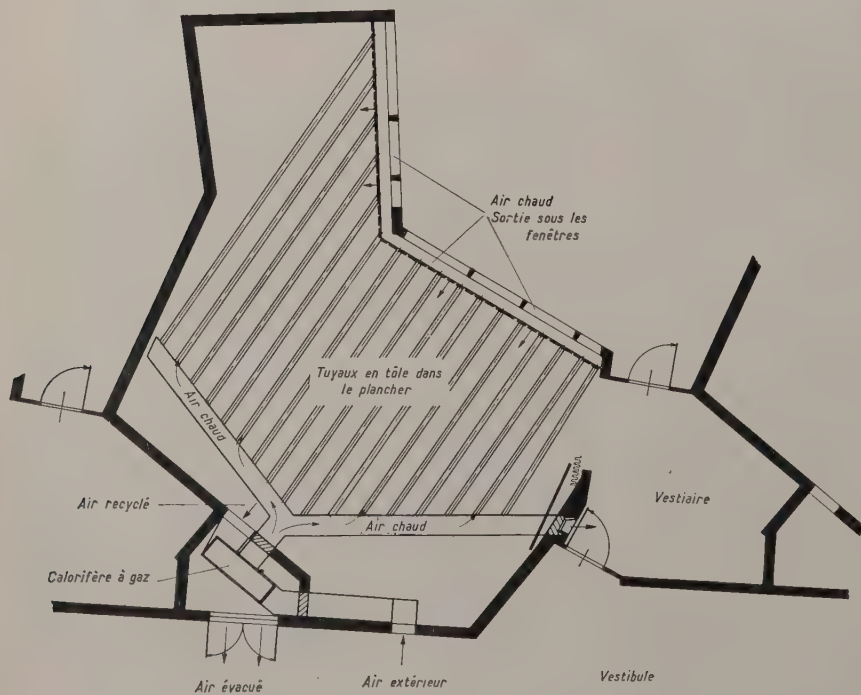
Plan d'une salle de classe avec chauffage à l'air chaud.
